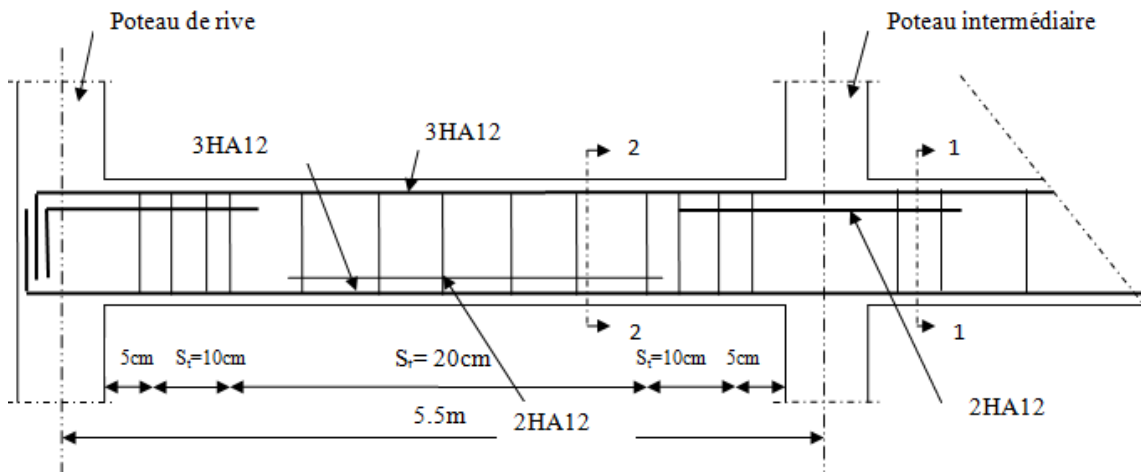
Schémas de ferrailage des poutres secondaires
